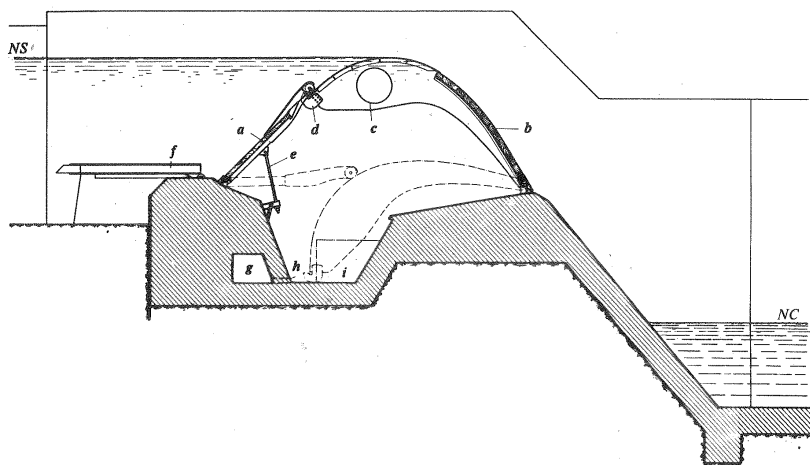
Sección de una presa con compuerta de tejado. a) compuerta superior; b) compuerta inferior; c) tubo flotador; d) gancho para limitar el alza de la compuerta inferior; e) tirante para limitar el alza de la compuerta superior; f) apoyos reversibles para un cierre de emergencia; g) canal de purga; h) foso de limpieza; i) abertura de paso desde la válvula de mando a la cavidad debajo del tejado y de ésta a la válvula de descarga.
